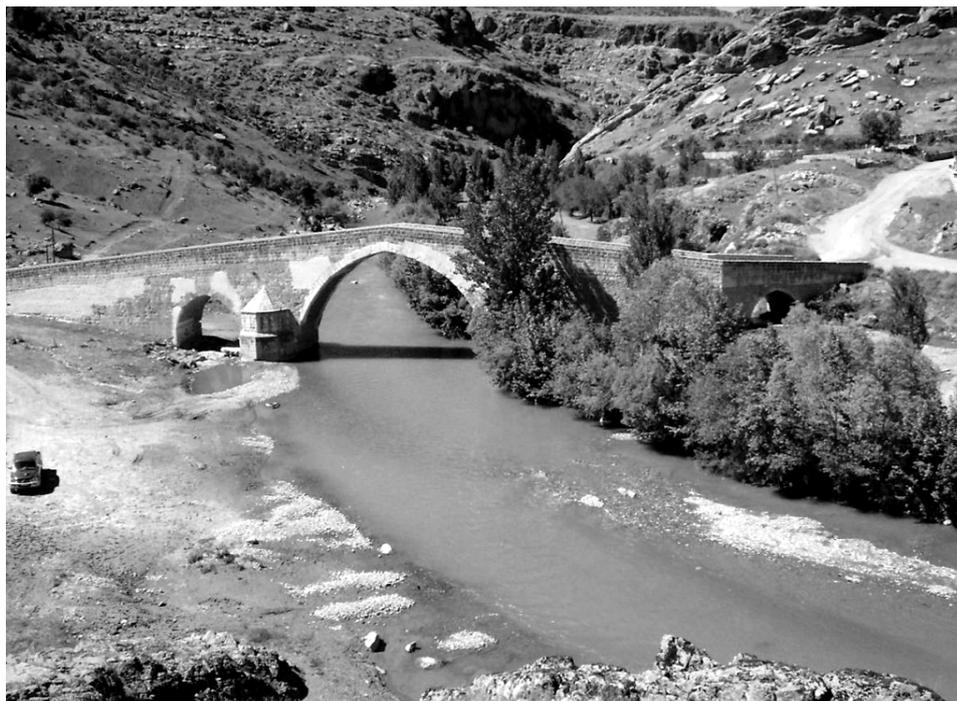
Çermik, Haburman Köprüsü. Prospetto meridionale.
